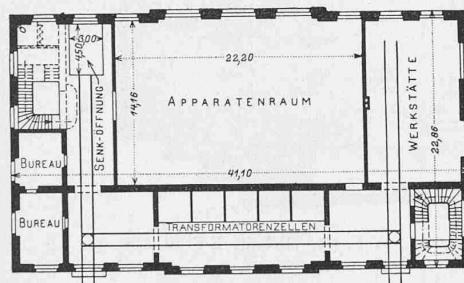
Grundriss vom Obergeschoß der Zentrale. — 1:600.
